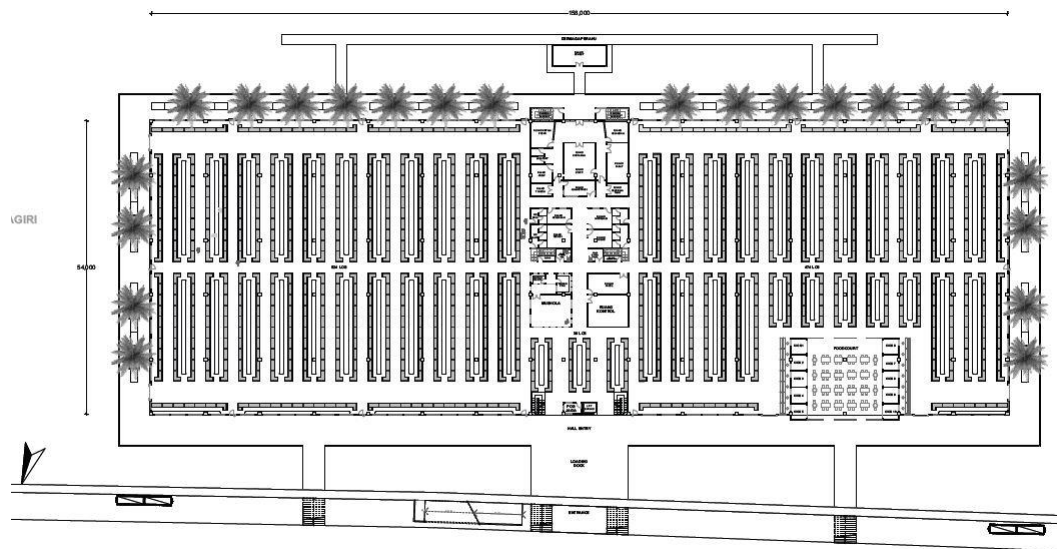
Siteplan Bangunan Pasar Selodang Kelapa
